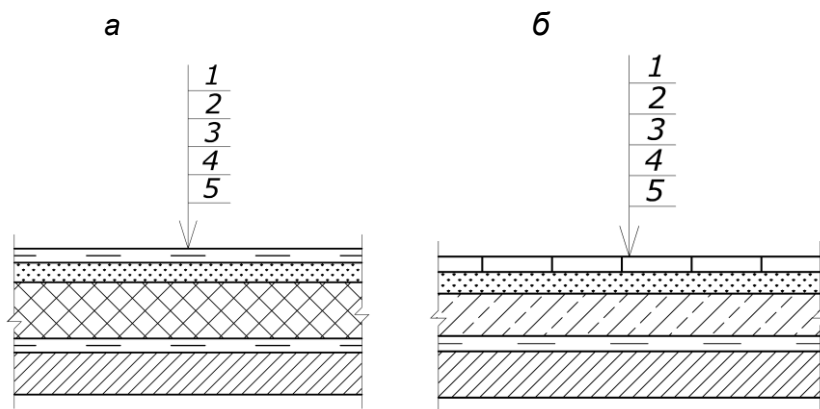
Состав: а – покрытия; б – перекрытия
